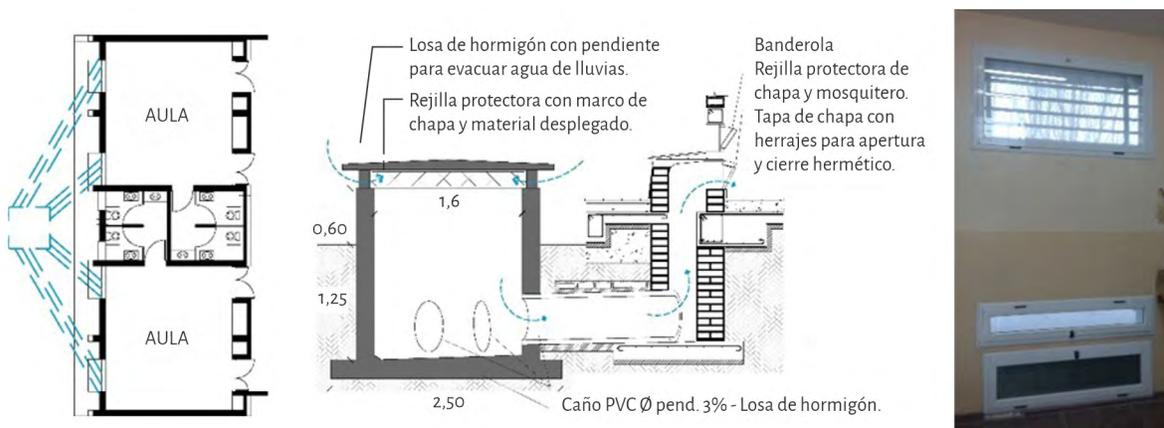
Escuela Bioclimática Cristóbal Colón. Detalles del pozo tipo canadiense. A) Planta de ductos enterrados. B) Corte. C) Interior, banderola conectada al pozo. Fuente: Michaux et al, 2018.
